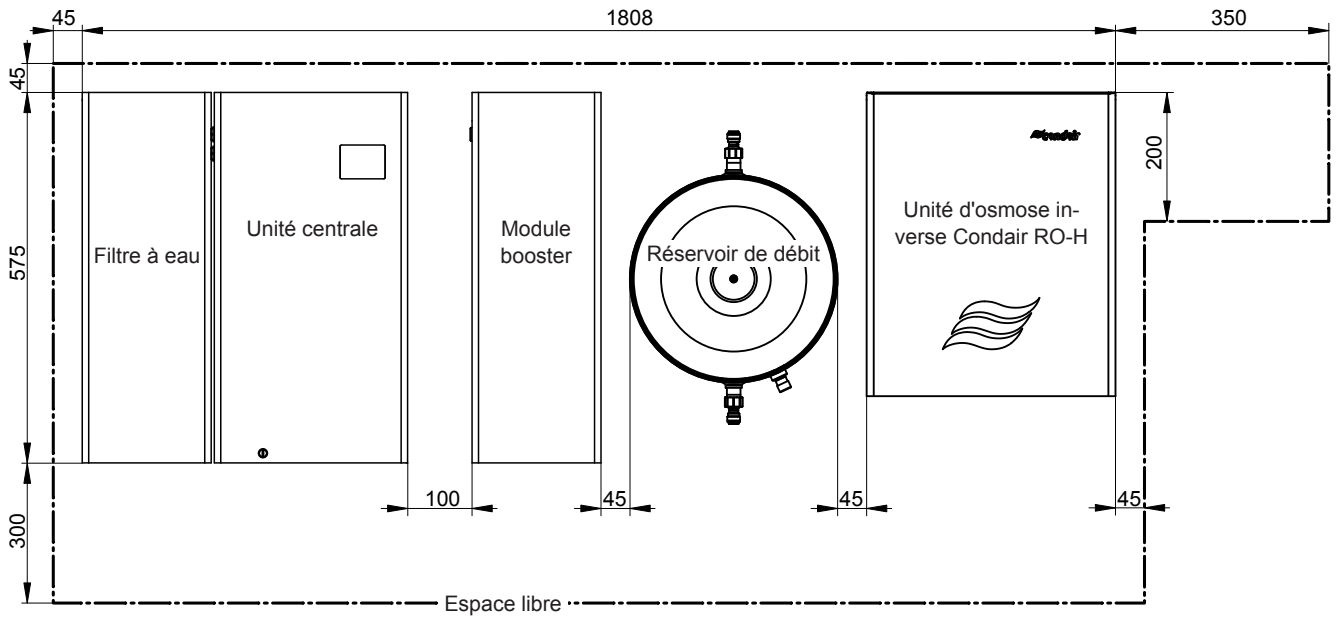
Exemple de placement 2 (dimensions en mm)
